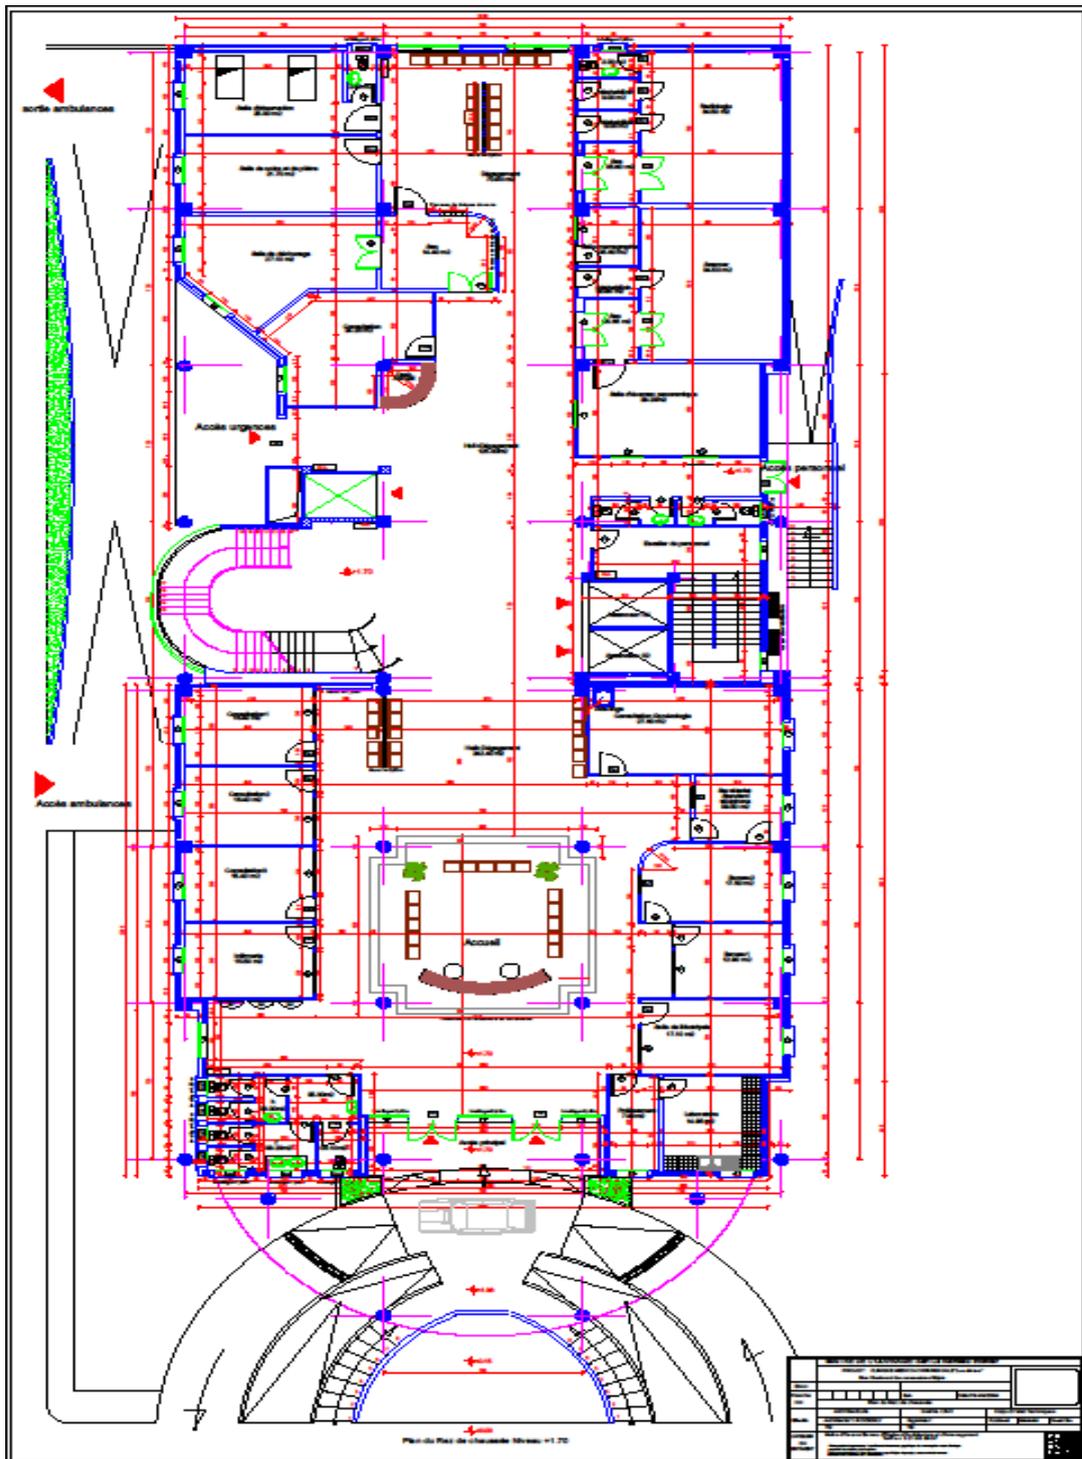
Plan du rez-de-chaussée de la clinique du RameauOlivier
